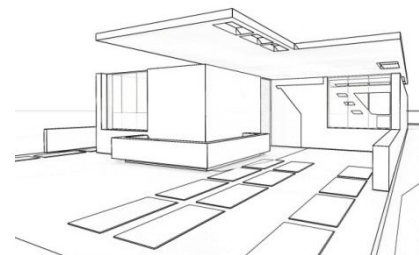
Esquema cubierta. Fuente: Elaboración propia.
